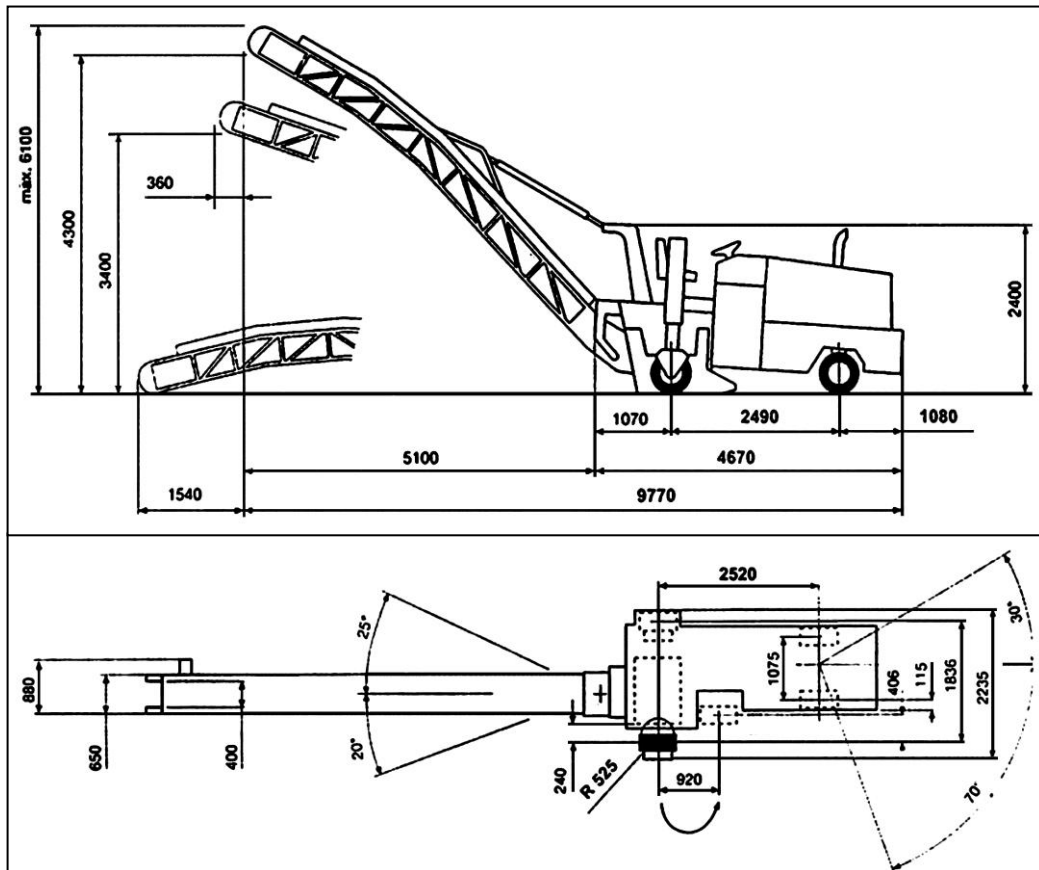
Cold Milling Machine dan truck pengangkut
